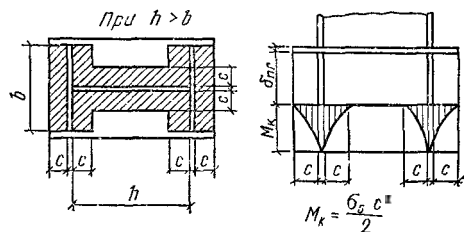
Опирание колонны непосредственно на плиту (рабочая площадь плиты заштрихована; справа — расчетная схема)
